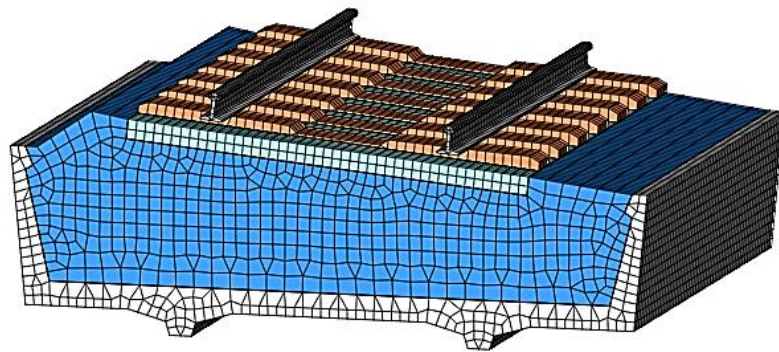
Конечно-элементная модель железобетонного балластного корыта, путь на железобетонных шпалах, эксцентриситет пути отсутствует, возвышение наружного рельса – 15 см
